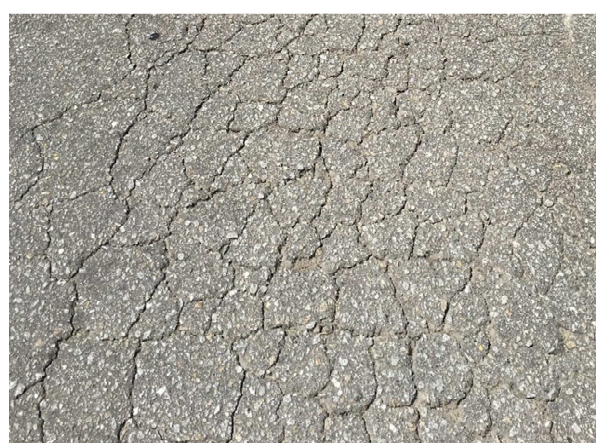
Fendas no pavimento na Avenida Visconde de Oliveira
